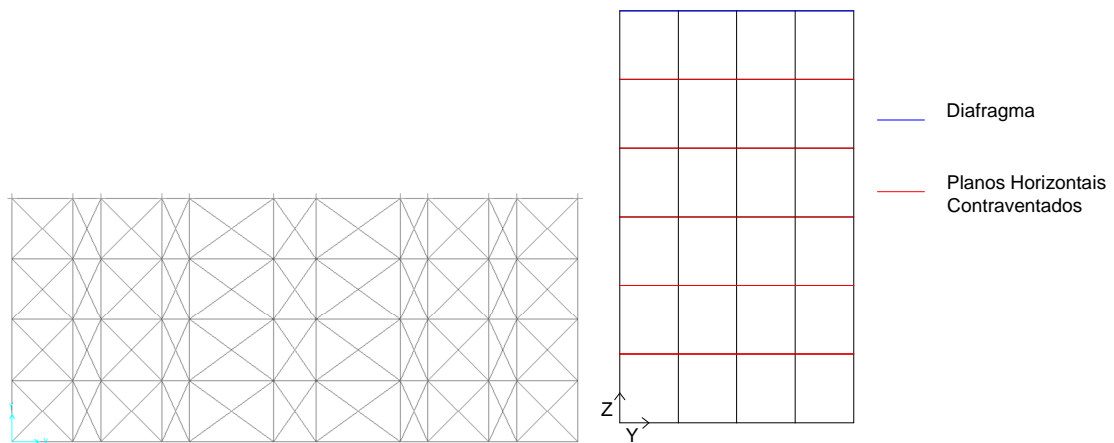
Configuração dos Planos de Contraventamento Horizontal Com Elementos de Contraventamento Pequenos
